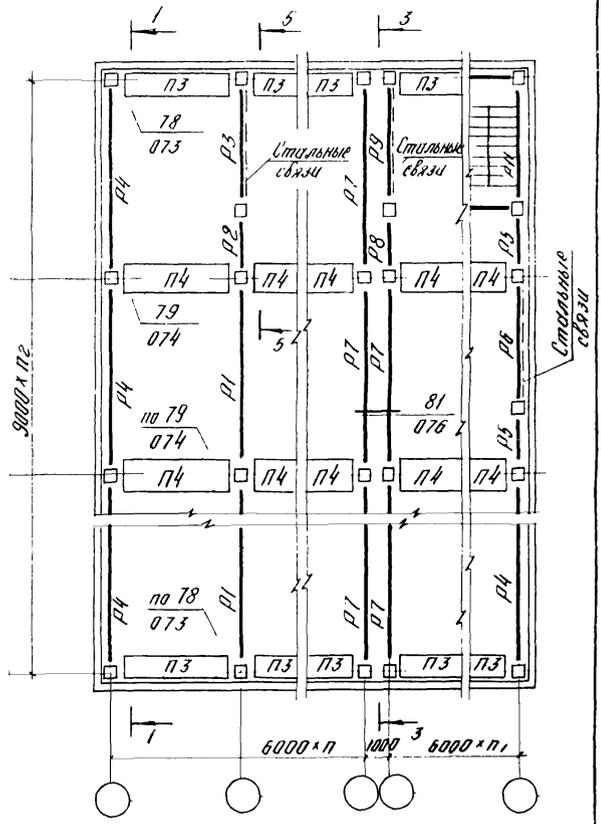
Схема расположения ригелей и связевых плит в перекрытиях здания с сеткой колонн 9х6 м
